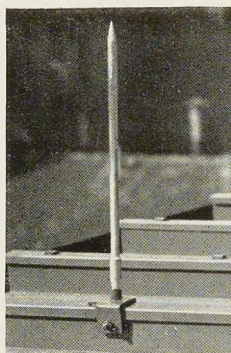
La toiture est composée de panneaux en tôle à simples plis, recevant un U formant couvre-joint. Ce système a fait preuve d'une bonne étanchéité.
